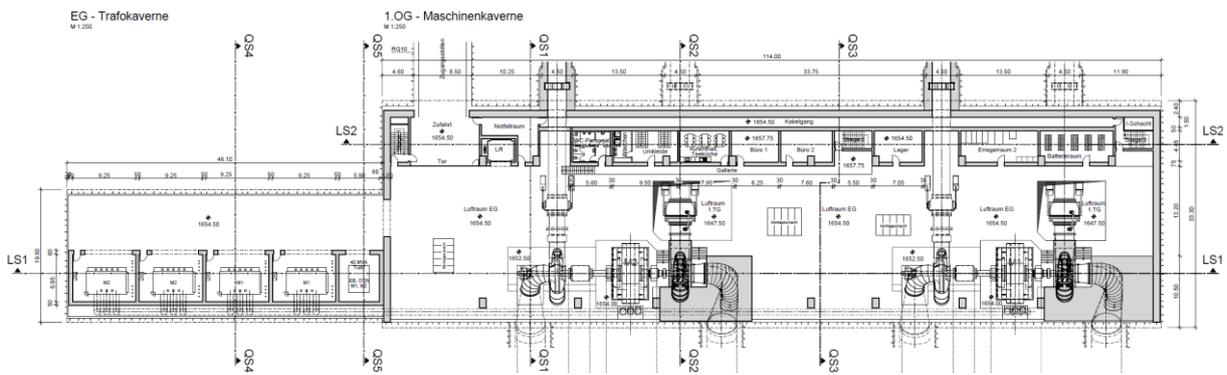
Grundriss Maschinen- und Trafokaverne (siehe Beilage 5.1)
